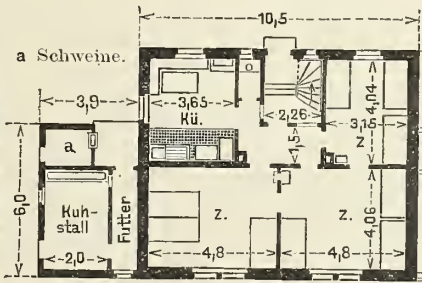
Grundriß zu Abb. 6. Zweifamilienhaus.
